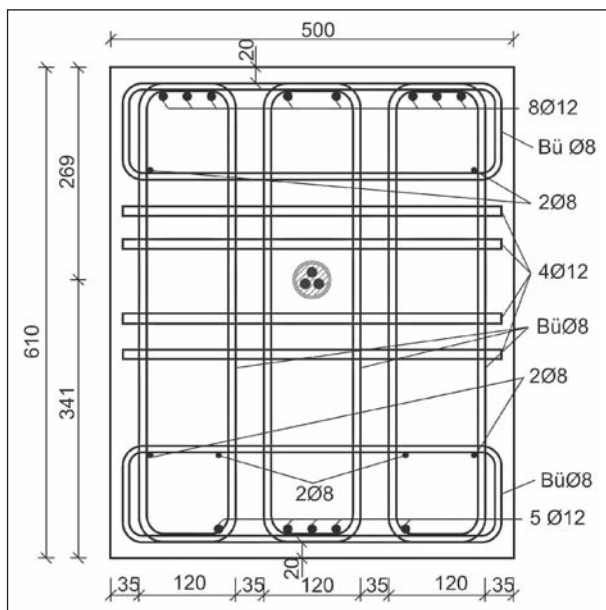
Darstellung der Bewehrung im Lasteinleitungsbereich
